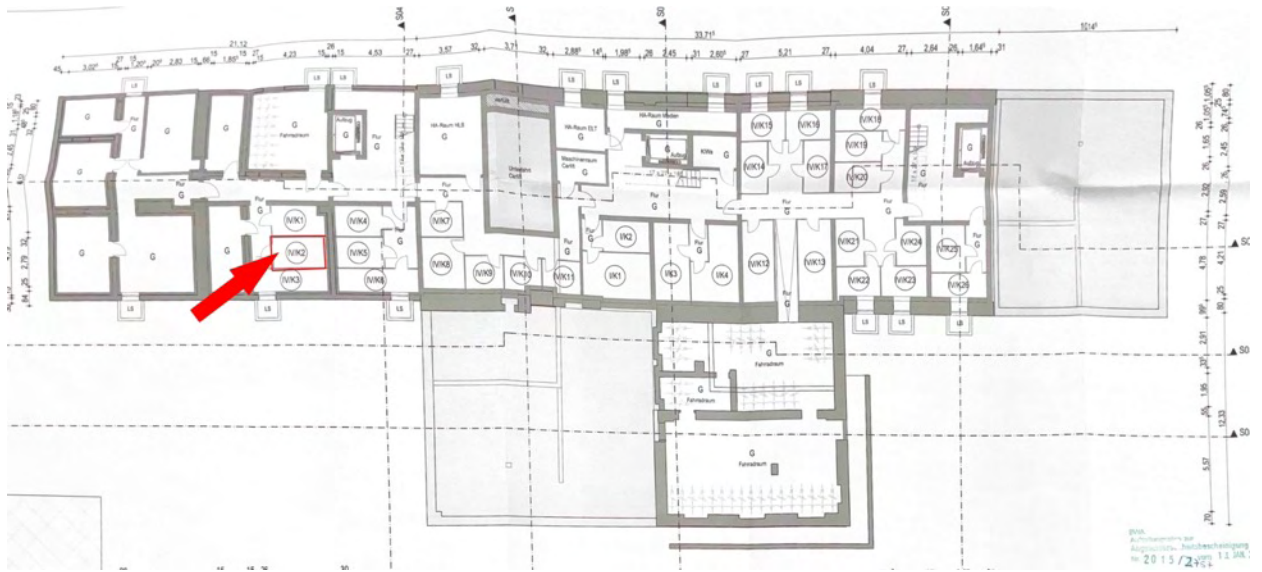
Grundriss Aufteilungsplan, Kellergeschoss mit Keller Nr. IV/K2
